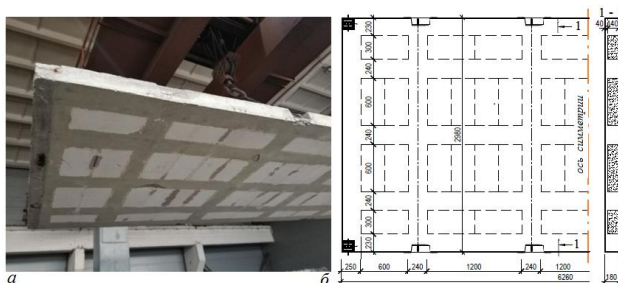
Железобетонная ребристая плита перекрытия с вкладышами из конструктивного ячеистого бетона: *а* – общий вид, *б* – геометрические размеры плиты
